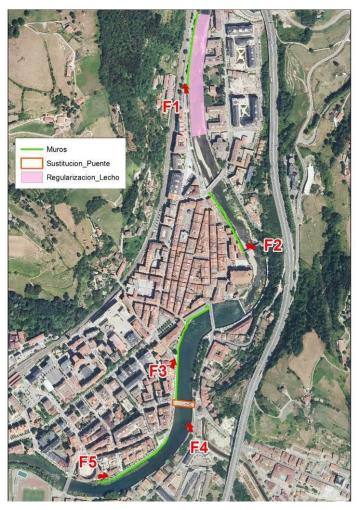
Ubicación en planta de las actuaciones y de las fotografías posteriores
